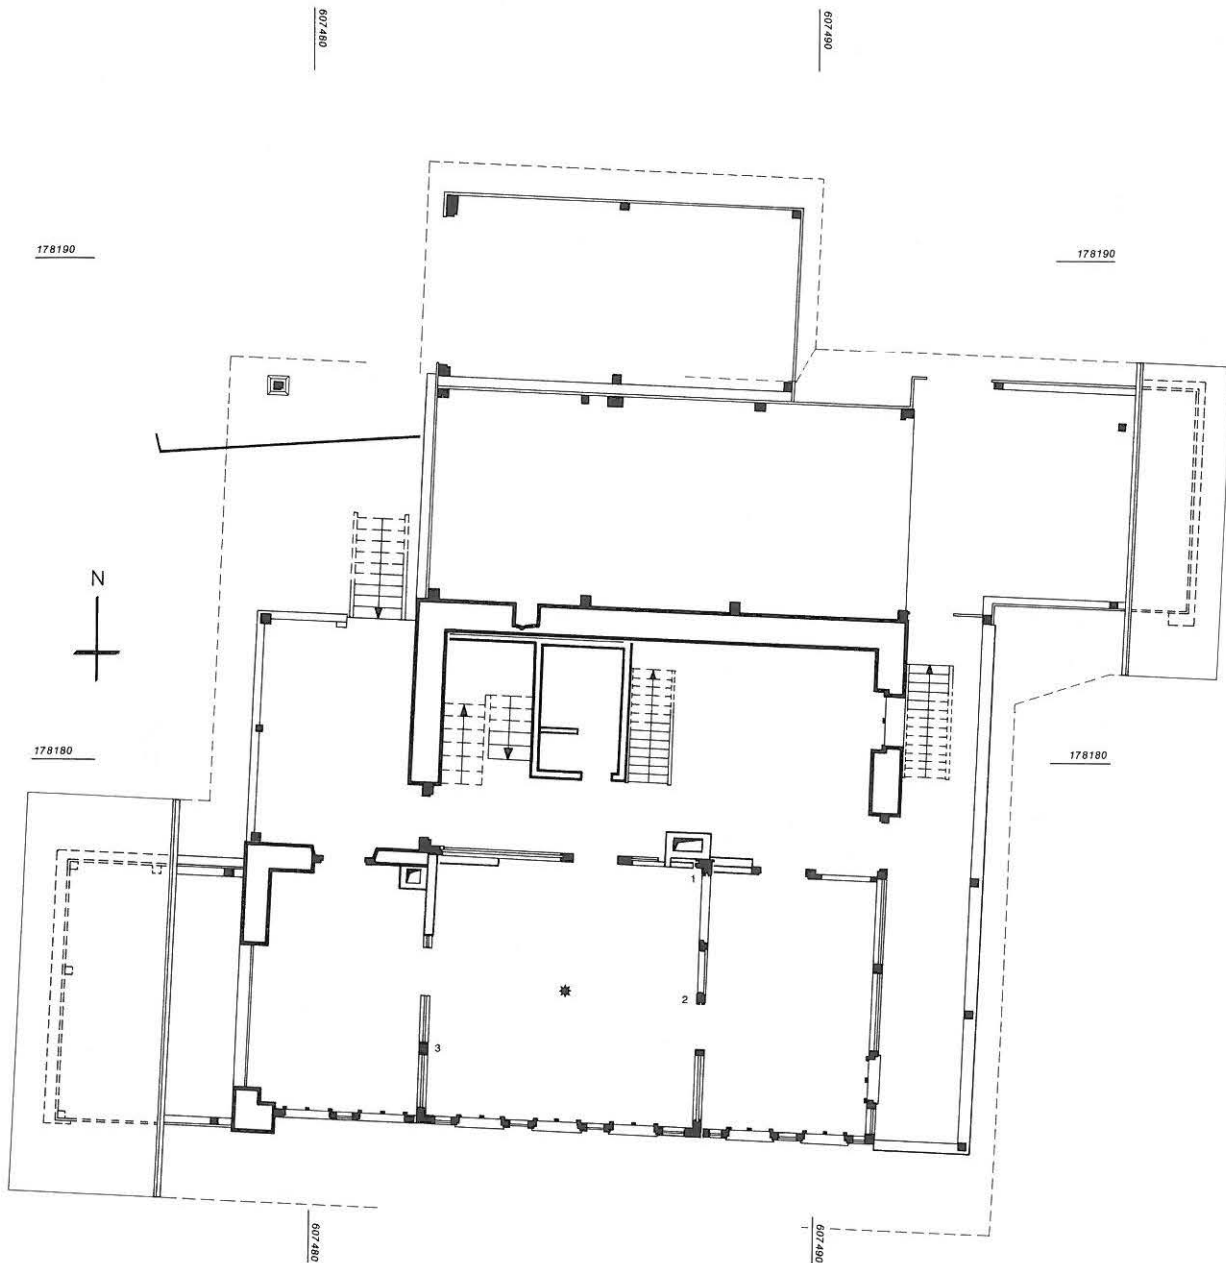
Längenbühl, Hattigen. Grundriss des 1. Obergeschosses. M. 1:150.
